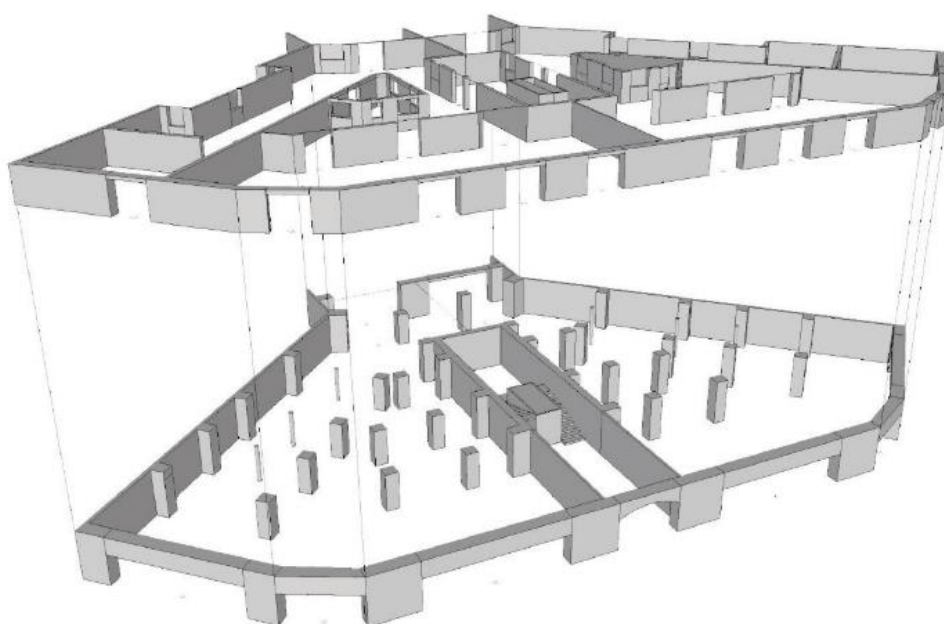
Representació 3D de la planta baixa i planta tipus del edifici ED02 de xamfrà amb els elements característics.¹
